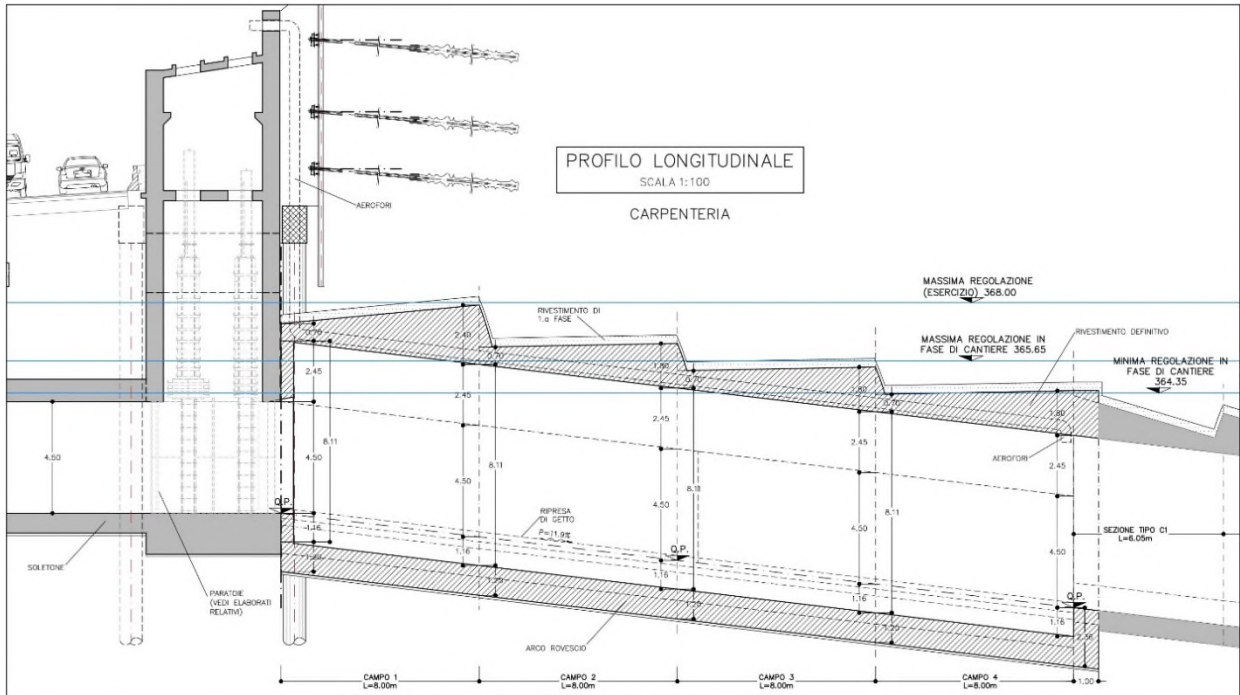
Sezione Camerone Convergente (campo finale) – Carpenteria – Profilo longitudinale
